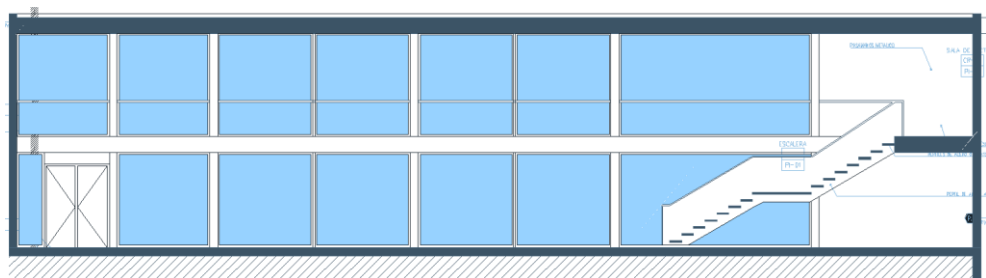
Plano Arquitectónico Corte 01 Biblioteca [25]
